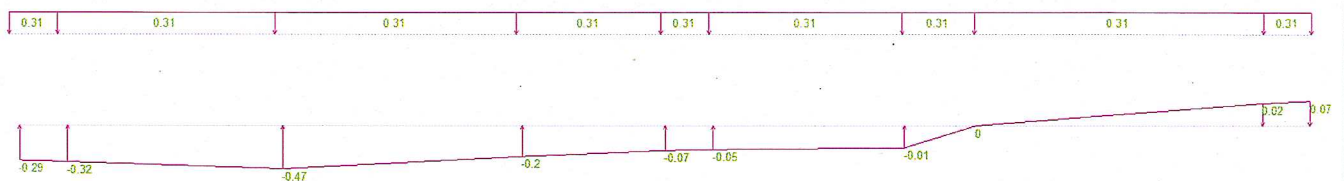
Схема приложения нагрузка на балку: а – нагрузка от собственного веса кровли,
